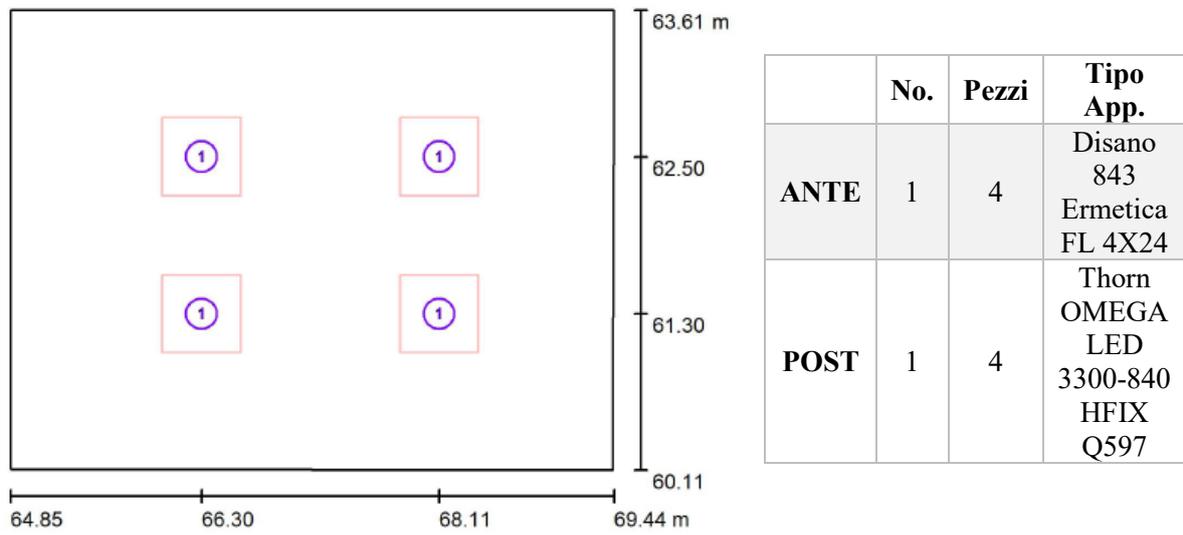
Disposizione in pianta degli apparecchi di illuminazione.
